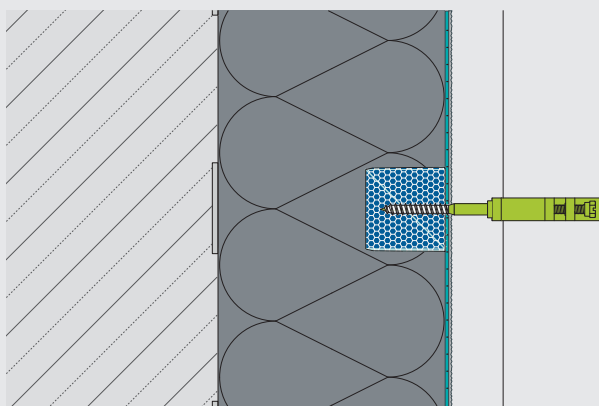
Montage im Dämmstoff – das Montageelement wird in die Dämmplatte verklebt und das Anbauteil im Montageelement befestigt.
